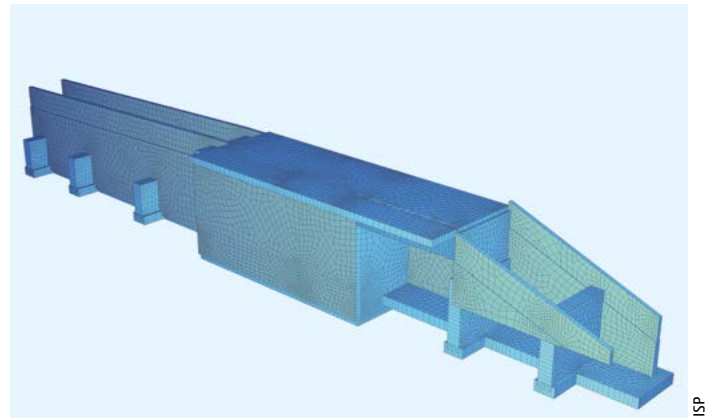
statisches Model der Schwergewichtskonstruktion inkl. Hausanschlussraum
